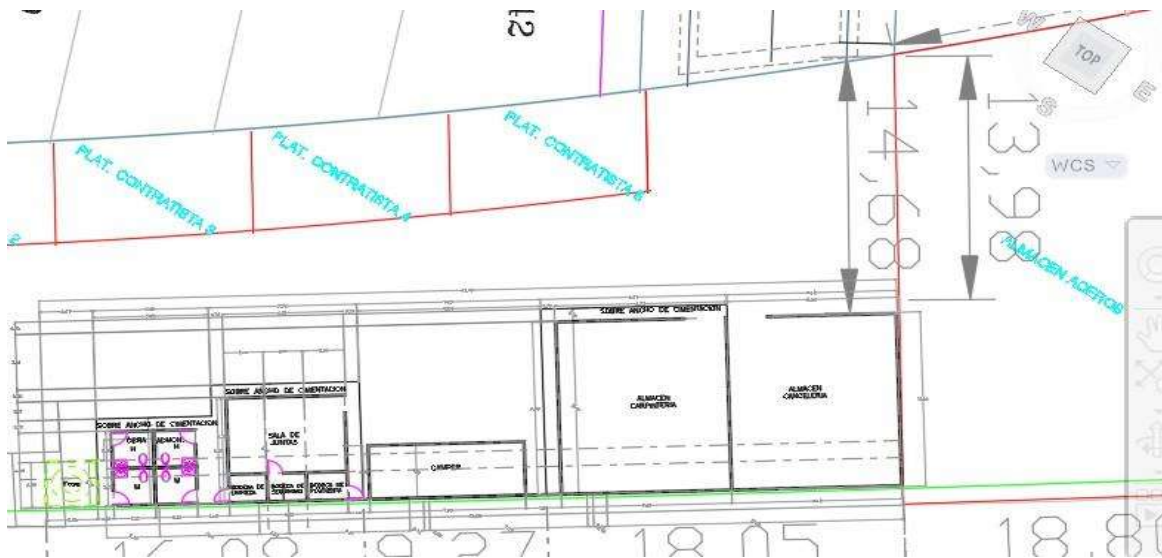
Planta de conjunto área de campamento del condominio Cantara en el desarrollo Cañadas del Arroyo de la constructora Urbana donde ejecute La supervisión de terracerías y la edificación de bodegas, patio de maniobras, sala de juntas, bodegas y sanitarios.
